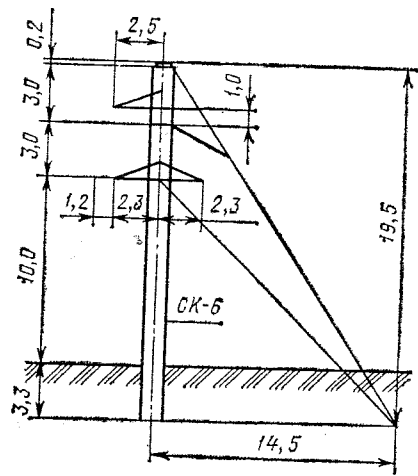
Конструкция унифицированной железобетонной одноцепной анкерно-угловой опоры 110 кВ
